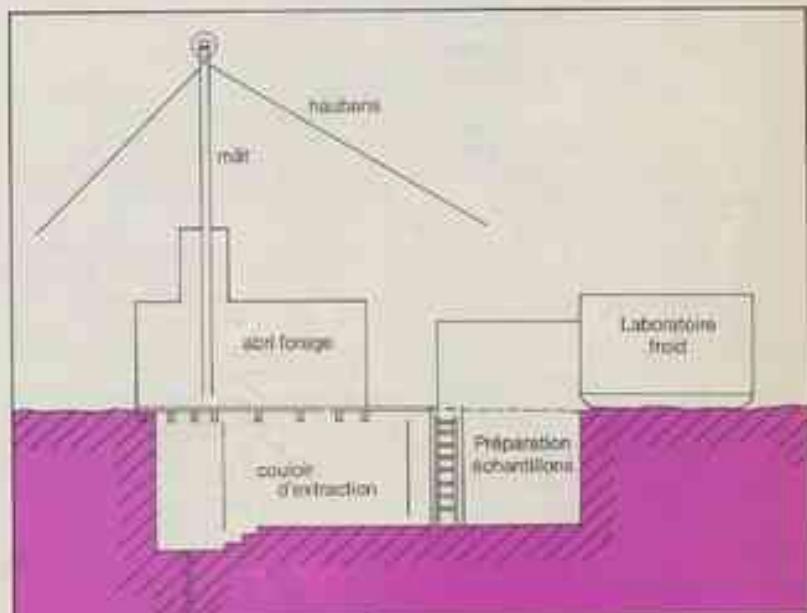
La plate forme de forage ainsi que l'abri sont montés sur un plancher en dessous duquel un module d'extraction est creusé de façon à atteindre la hauteur suffisante pour retirer le carottage de glace du tube carottier. La préparation, le découpage et le conditionnement des échantillons se font dans une cabine au bas de ce couloir tant que le laboratoire froid ne sera pas arrivé; ensuite, toutes nos manipulations se feront à l'intérieur de ce laboratoire à une température de -10 à -20°C. L'abri servira au stockage des échantillons à la fin des opérations de forage.
